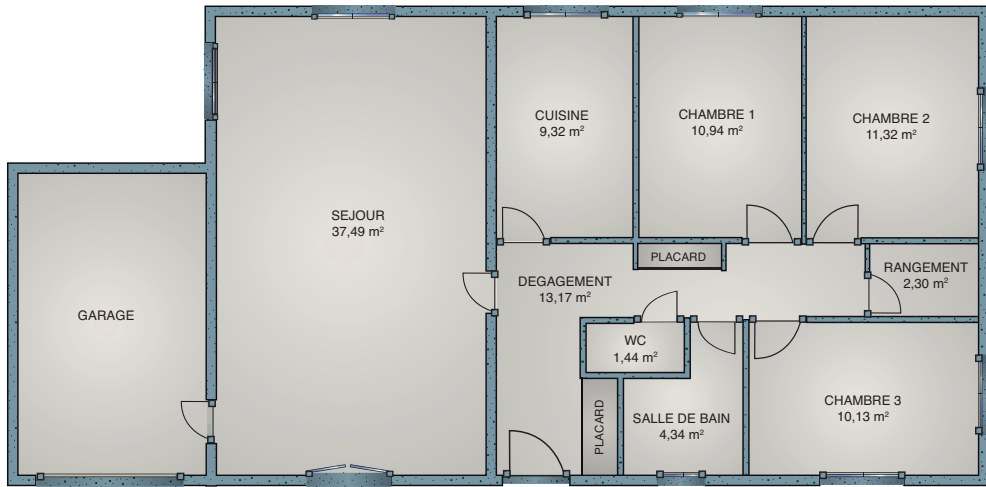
plan du rez-de-chaussée d'une maison Mozart
